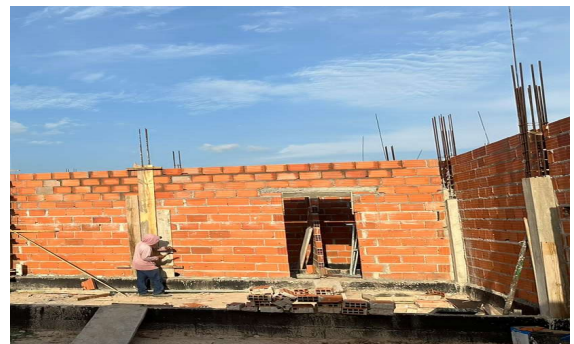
(2.3 Superestrutura) – Verga de portas
